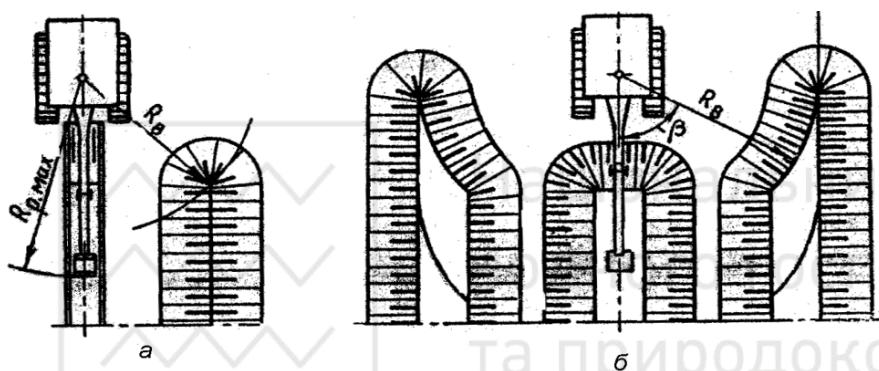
Схеми розробки виїмок екскаватором, обладнаним зворотною лопатою: *а* – траншеї; *б* – каналу
